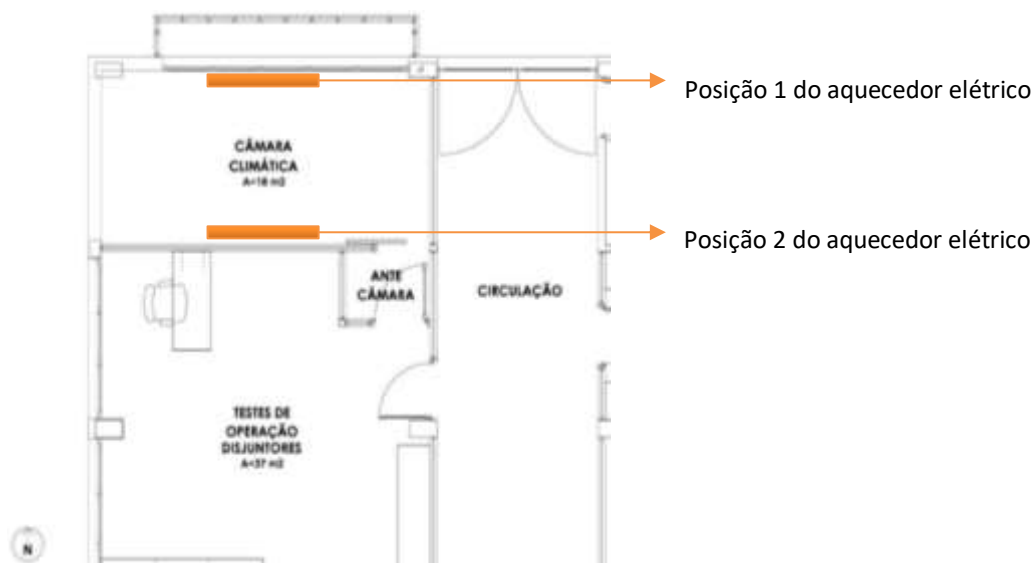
Planta baixa da câmara climática e ambientes adjacentes
